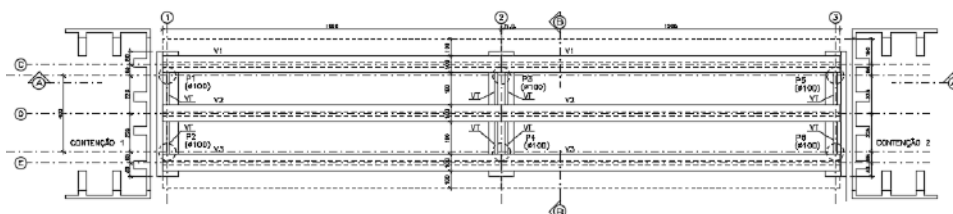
Vista superior das vigas pré-moldadas (desenho: EST-01_R05).
